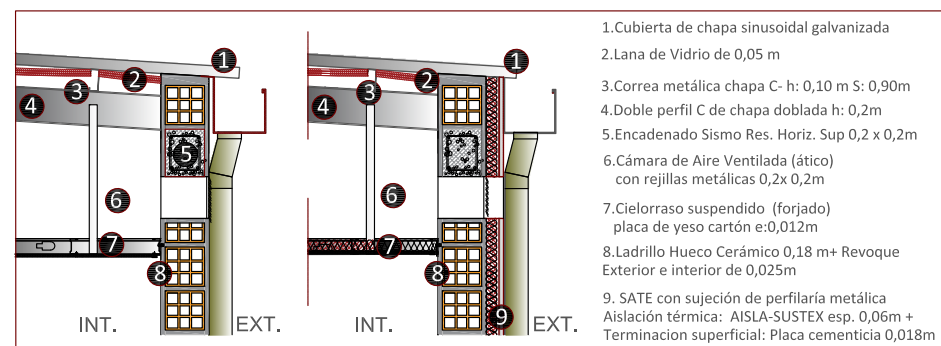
| Detalle constructivo caso base y mejorado con AISLA-SUSTEX. Fuente: elaboración propia.
